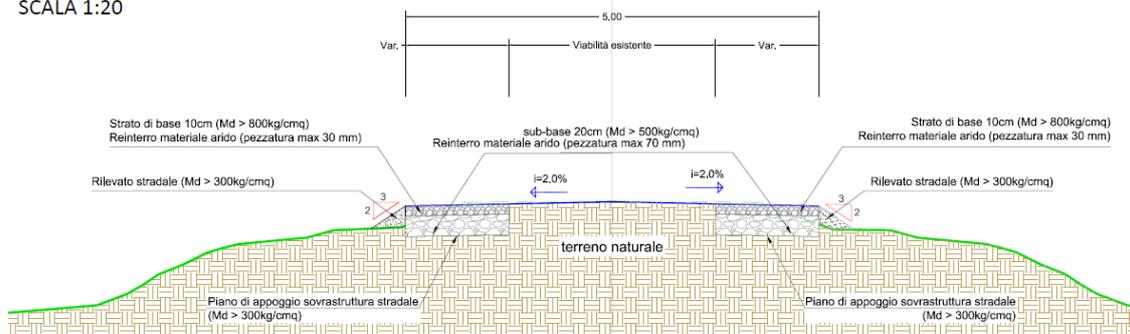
Sezione stradale tipo della viabilità esistente con adeguamenti stradali
